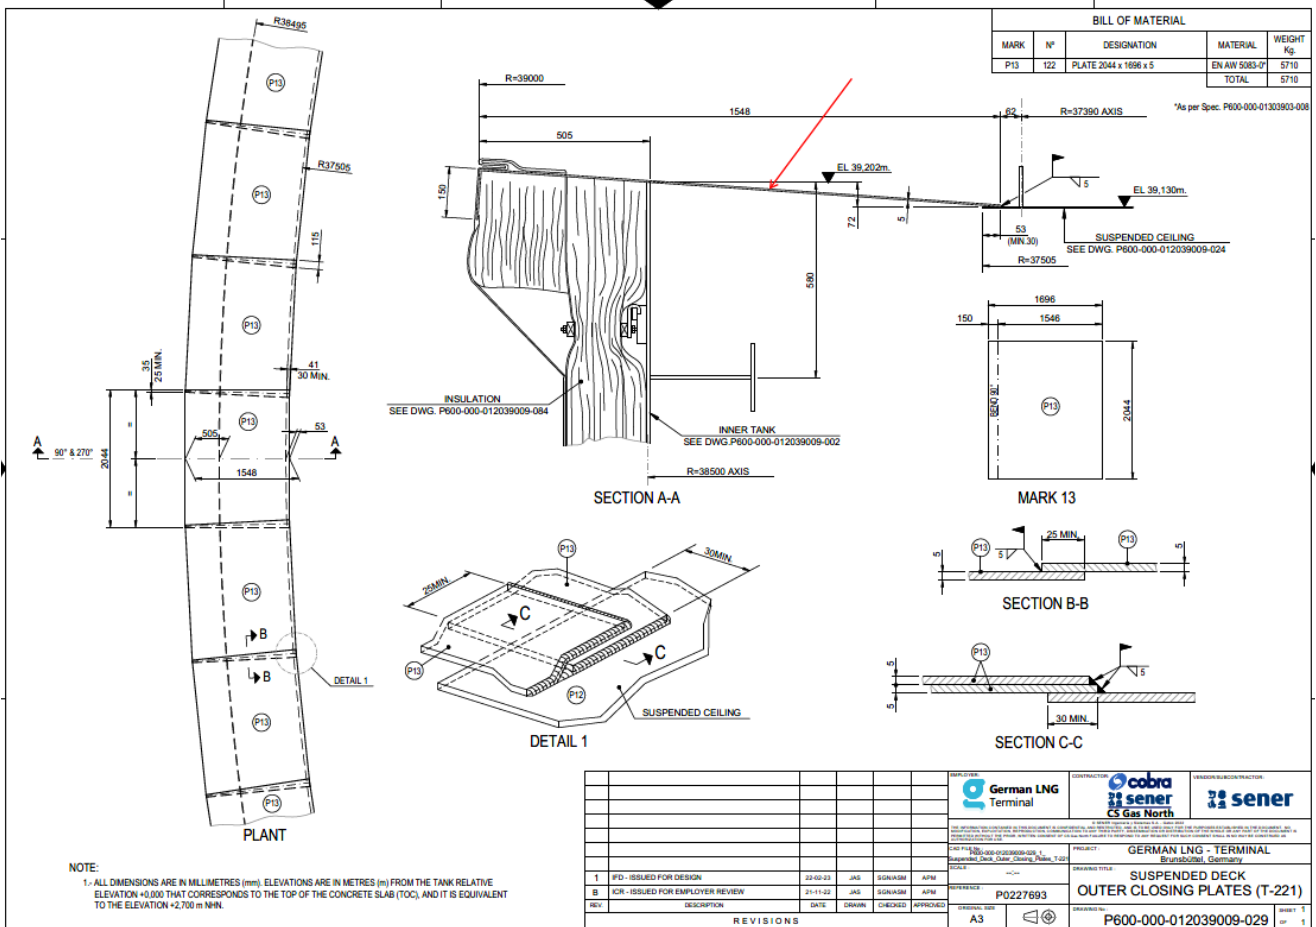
Entfernen der äußeren Bleche der abgehängten Decke (die Platten sind mit einem roten Pfeil gekennzeichnet)
